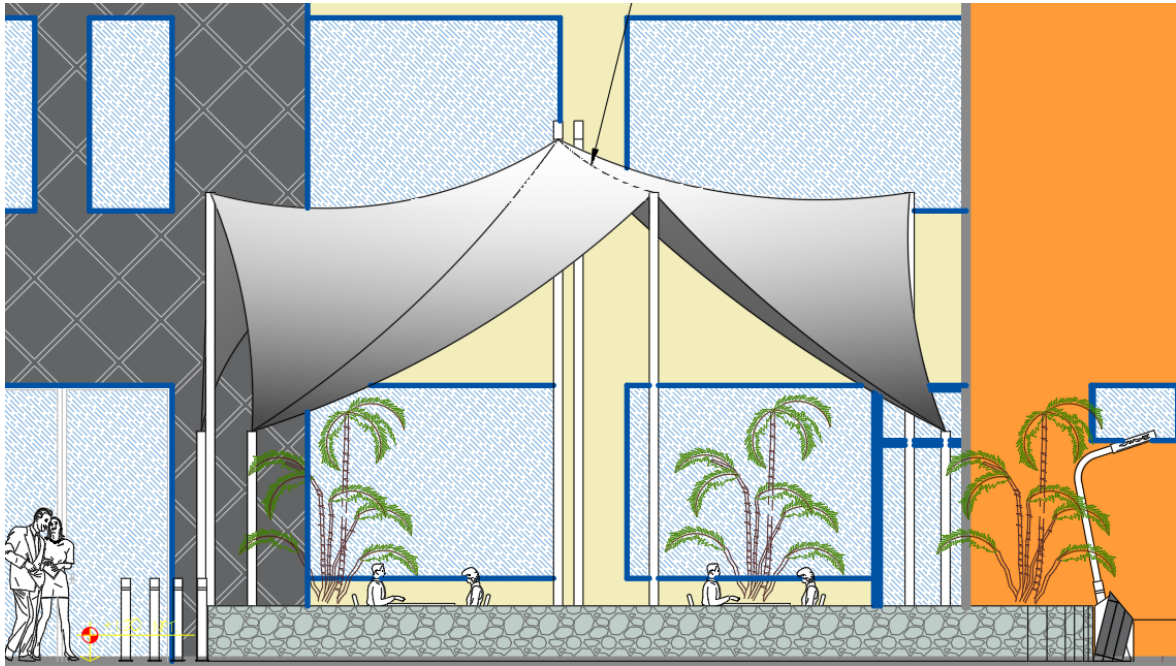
Detalle de cobertura tensionada. Elaboración propia
